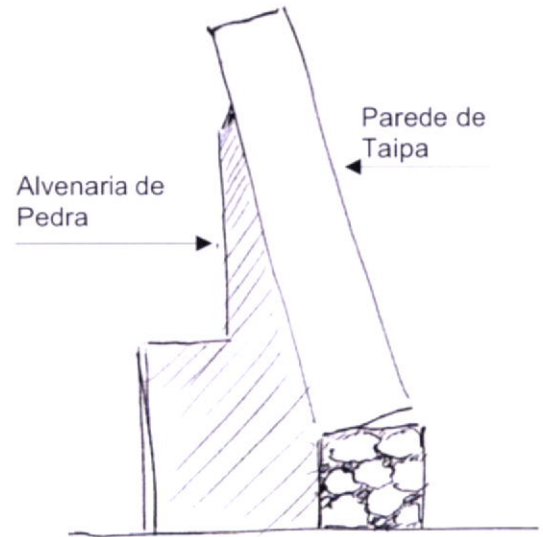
Pormenor da execução de reforço da base e enchimento em alvenaria de pedra, para correcção do desnível exterior da parede de taipa. Cancino.
